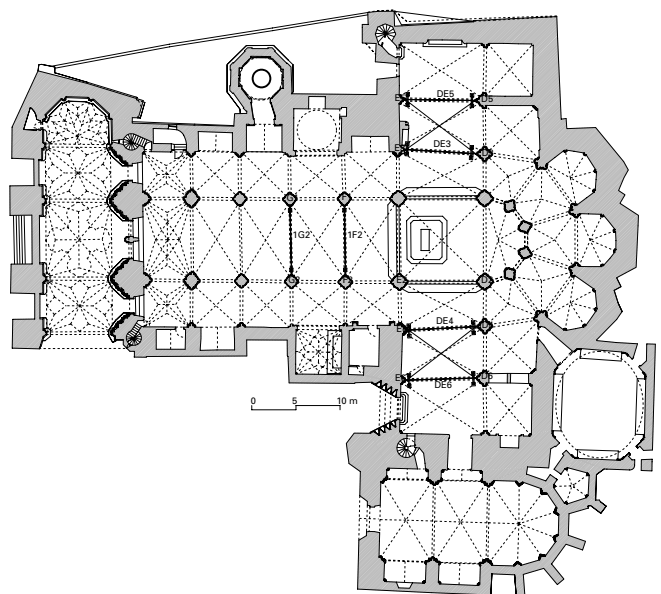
Situación de los pórticos provisionales de acero para acodalamiento de los pilares 3º y 4º de la nave y atirantado de las bóvedas del crucero
